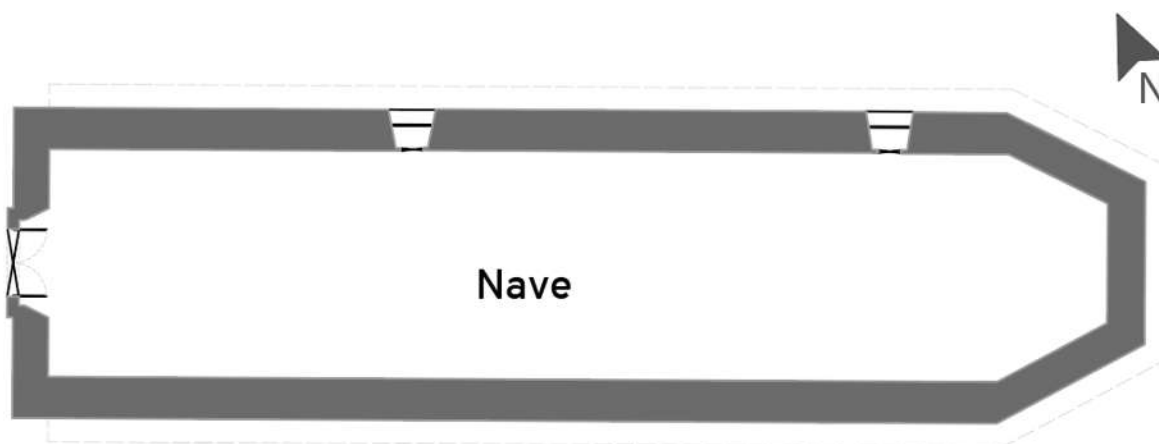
Planta de etapa constructiva de finales del siglo XVI. Elaboración propia.
